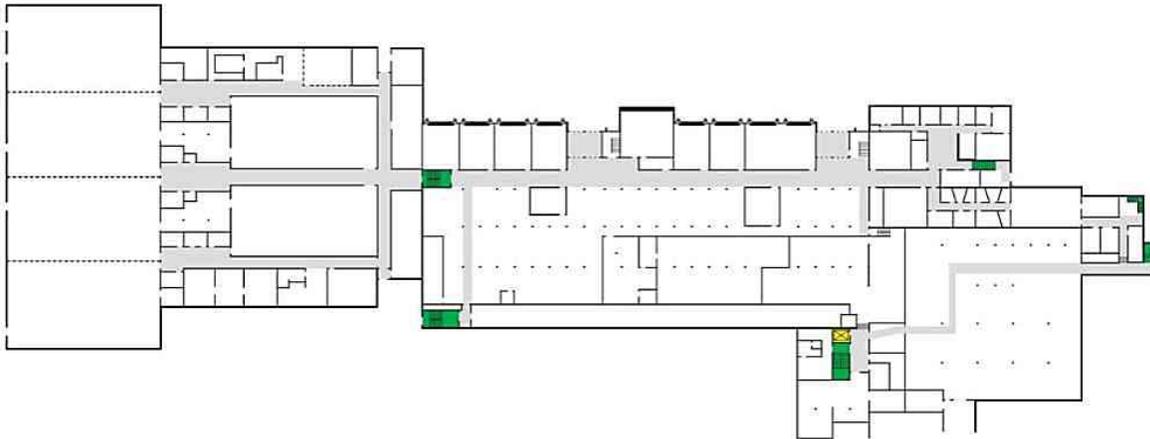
Plan du vaste rez-de-chaussée de l'école secondaire
